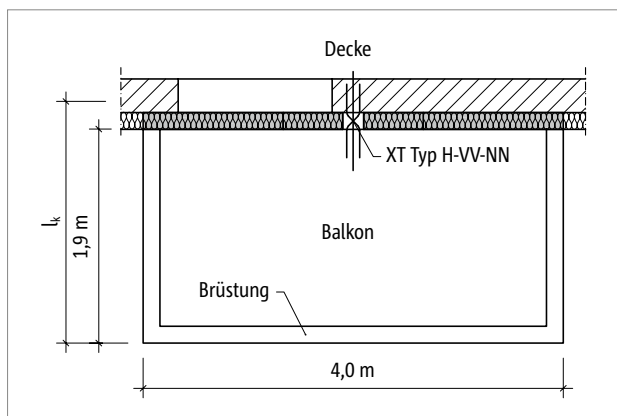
Schöck Isokorb® XT Typ K, H: Grundriss
